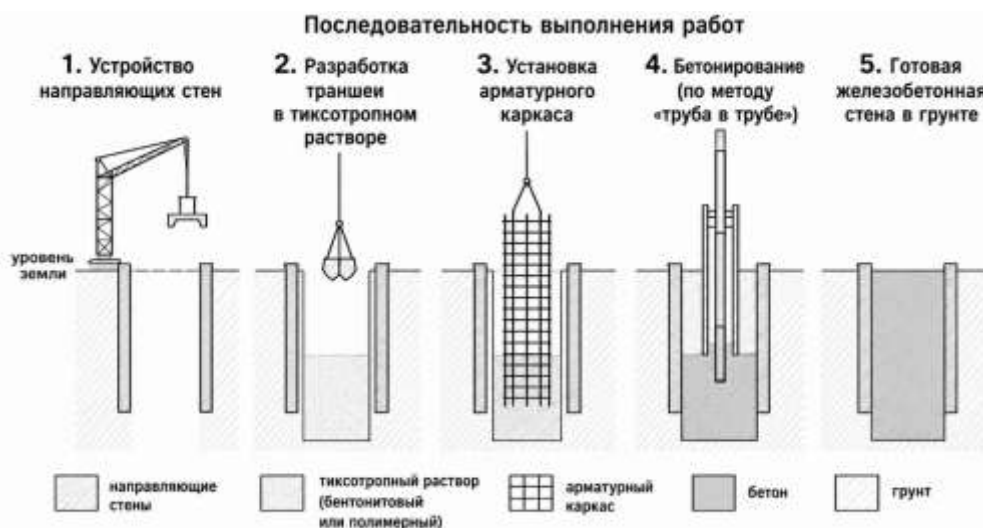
Схема ограждения котлована типа «стена в грунте»
